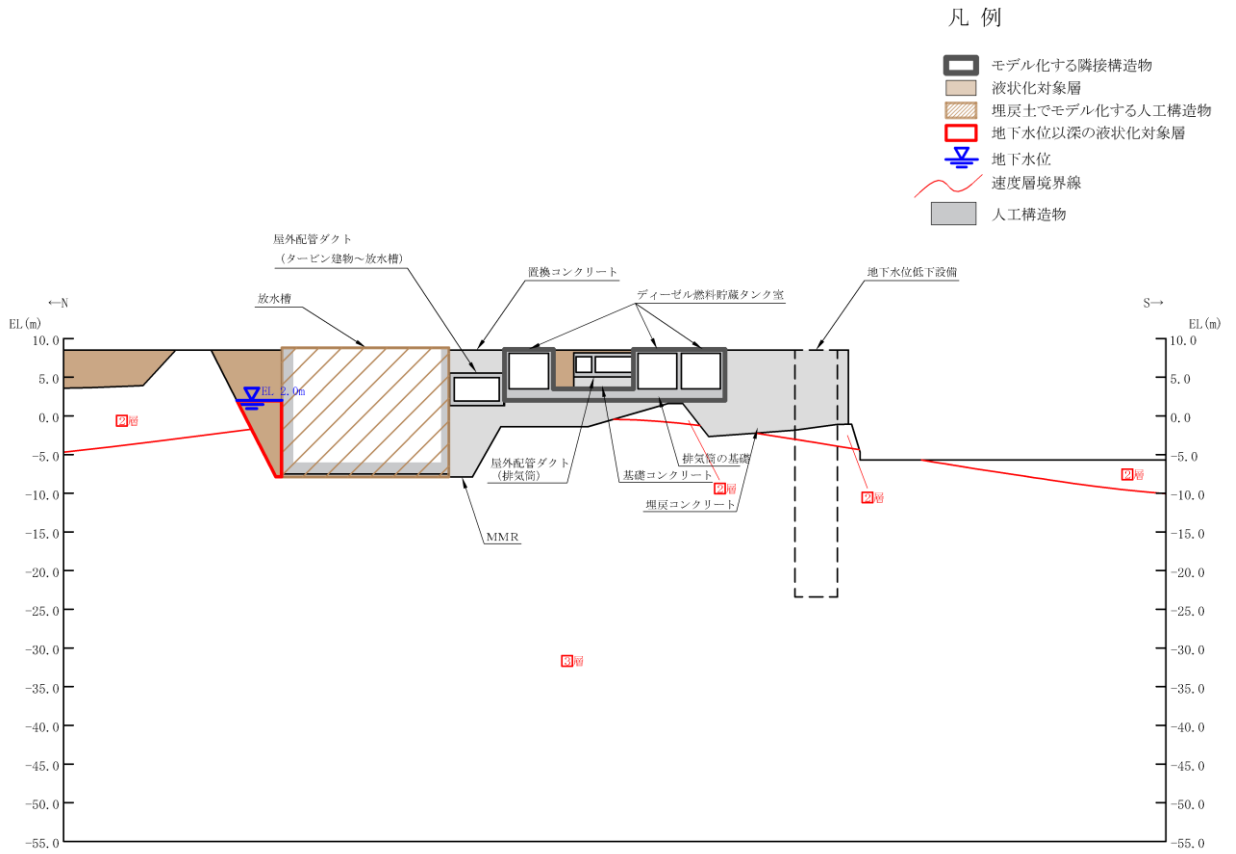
屋外配管ダクト (排気筒) 評価対象地質断面図 (A-A 断面位置)
